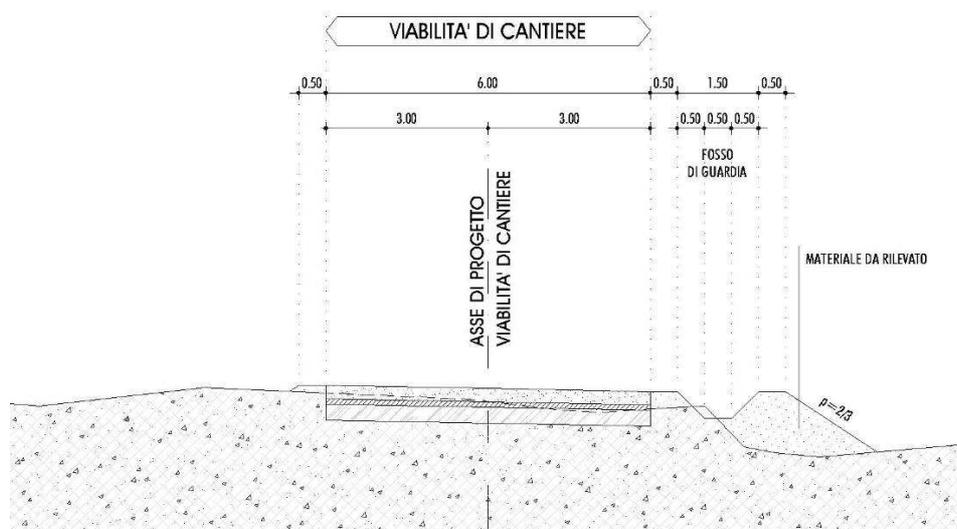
Stralcio sezione tipo viabilità di cantiere
